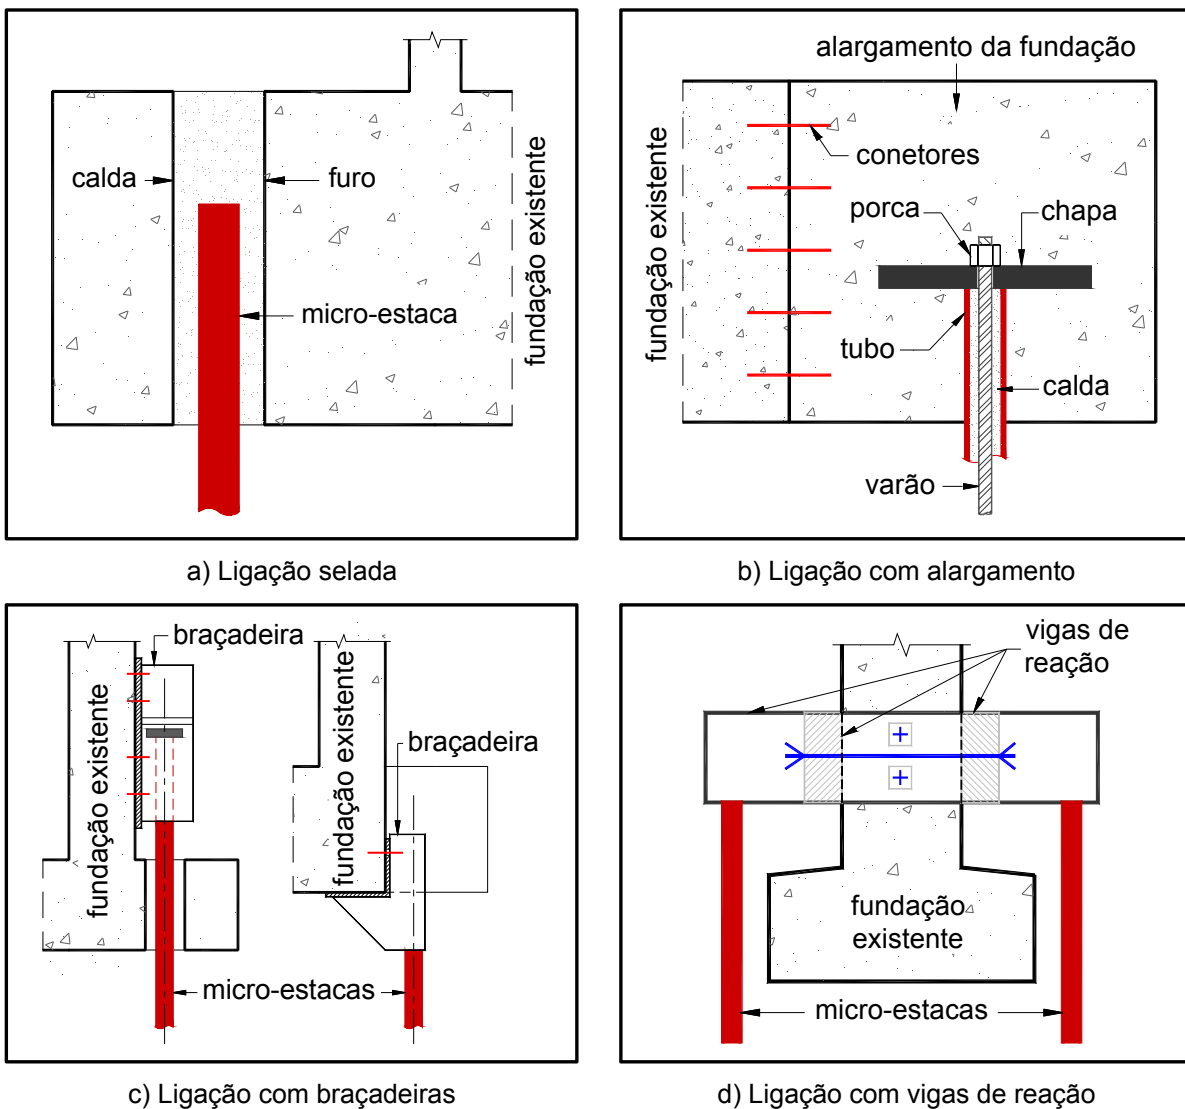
Ligações de micro-estacas a fundações de betão armado
